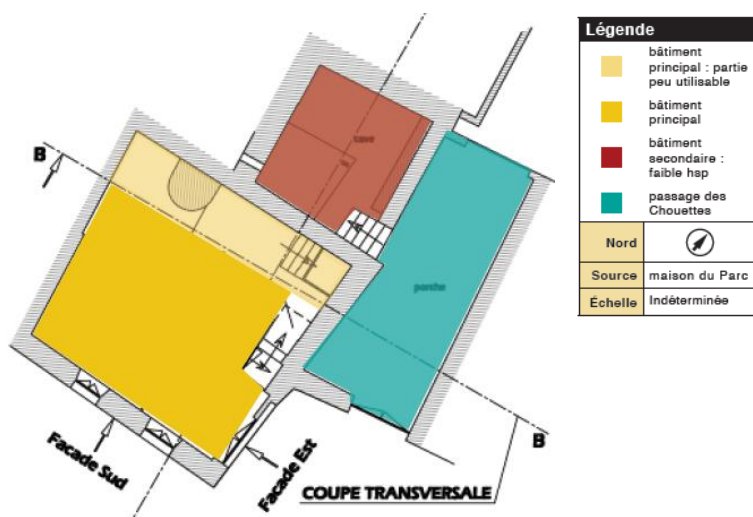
Plan du rez-de-chaussée du bâtiment existant
